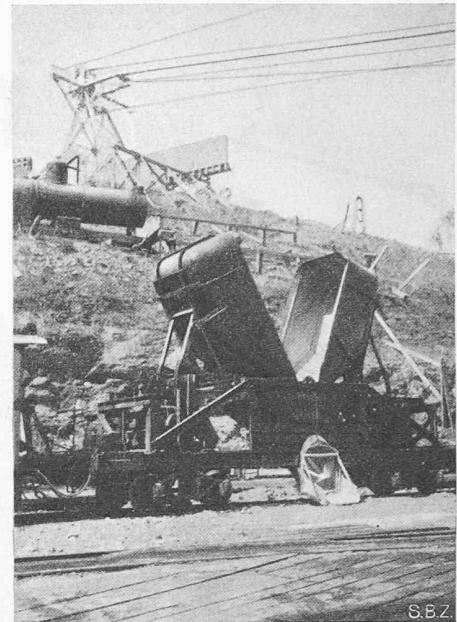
Betondoppelkippwagen (auf Normalspurgleis) zum Betontransport zwischen Betonieranlage und Kabelkran. Inhalt 5,7 m³
